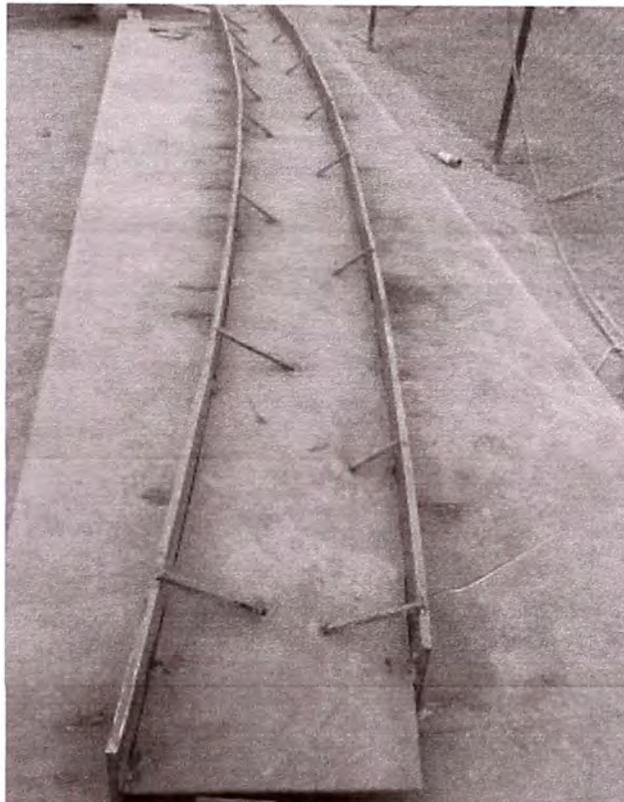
Armado de vigas roladas con arriostres de refuerzo
